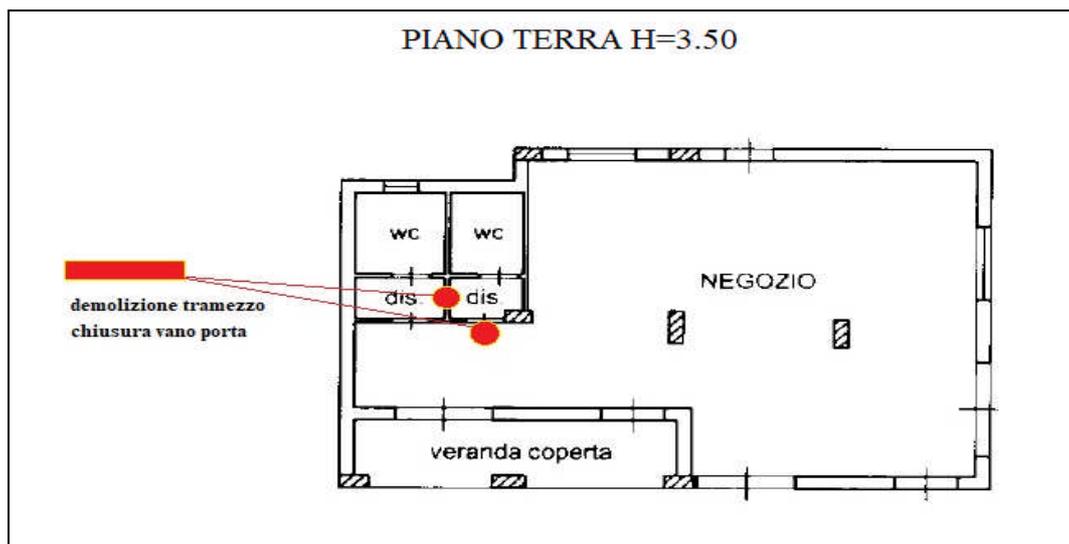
RAPPRESENTAZIONE DELLE DIFFORMITÀ SULLA PLANIMETRIA CATASTALE
